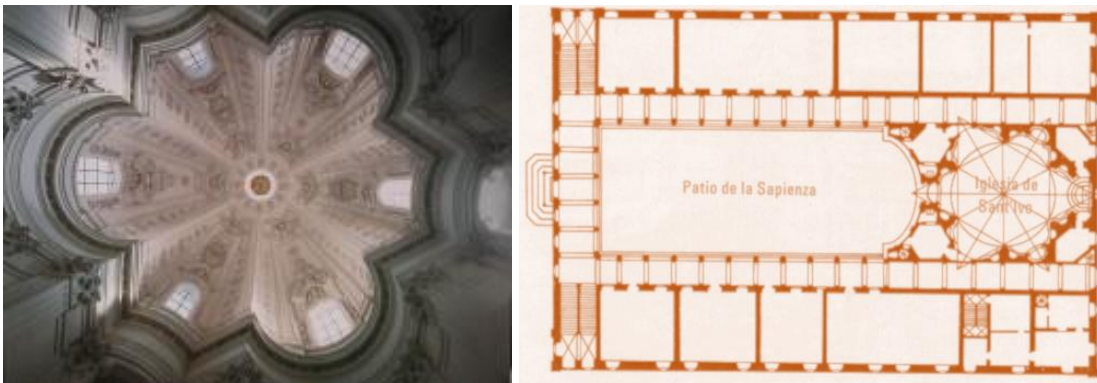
Vista interior de la cúpula de la Iglesia de Sant'Ivo y planta.
